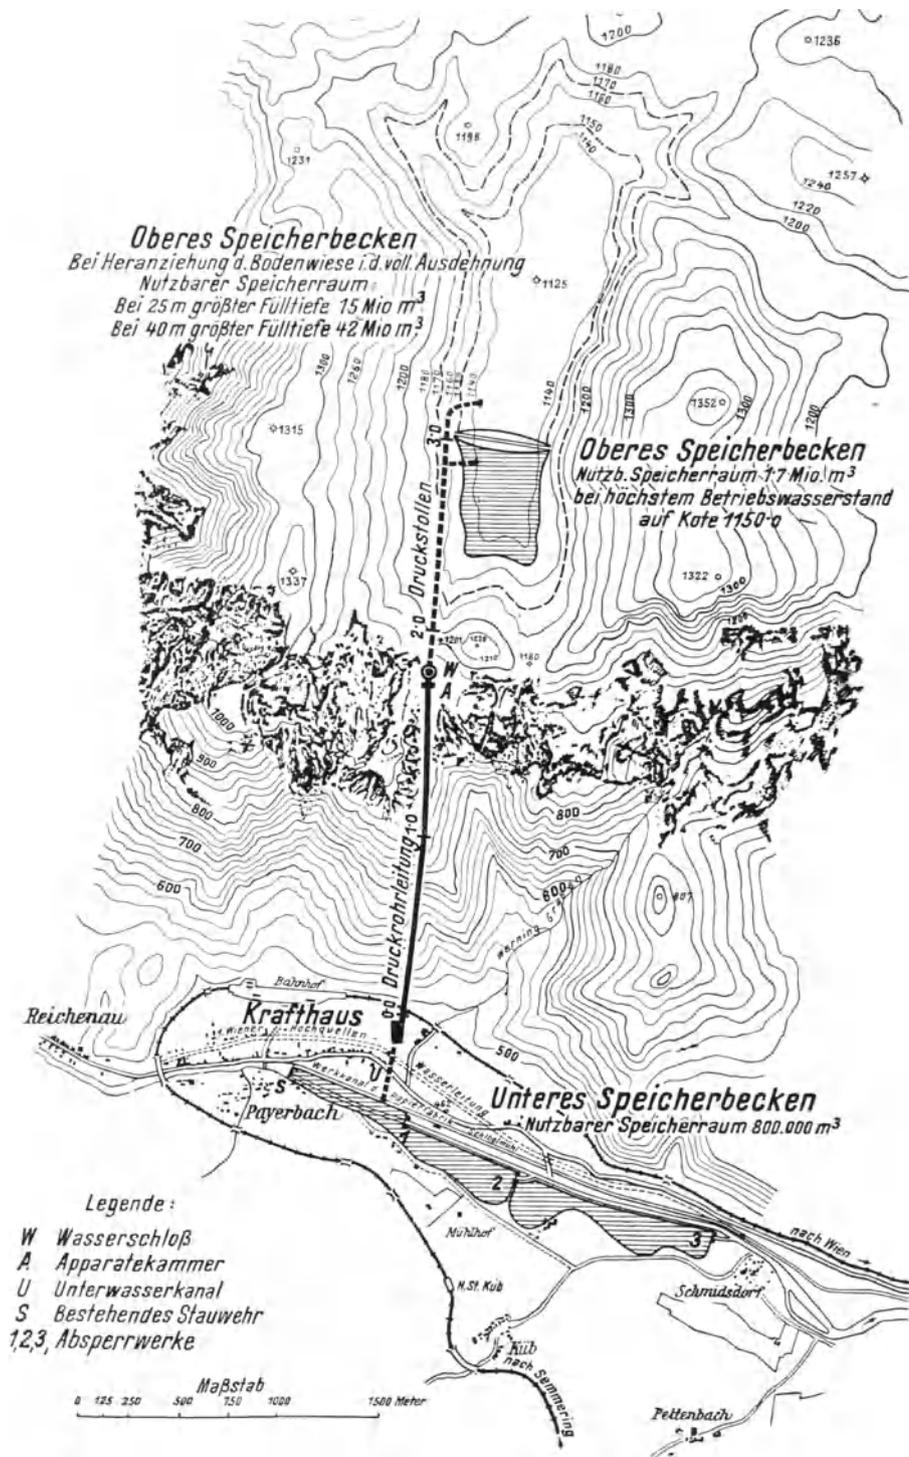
Entwurf K. Söllner, Pumpspeicherwerk Payerbach-Bodenwiese, Übersichtslageplan
